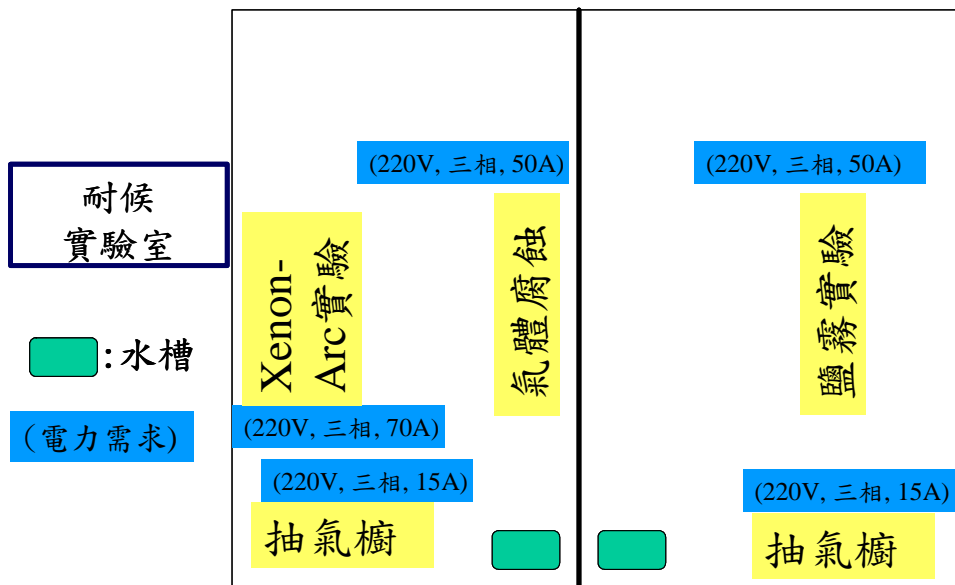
耐侯實驗室實驗儀器配置平面圖
